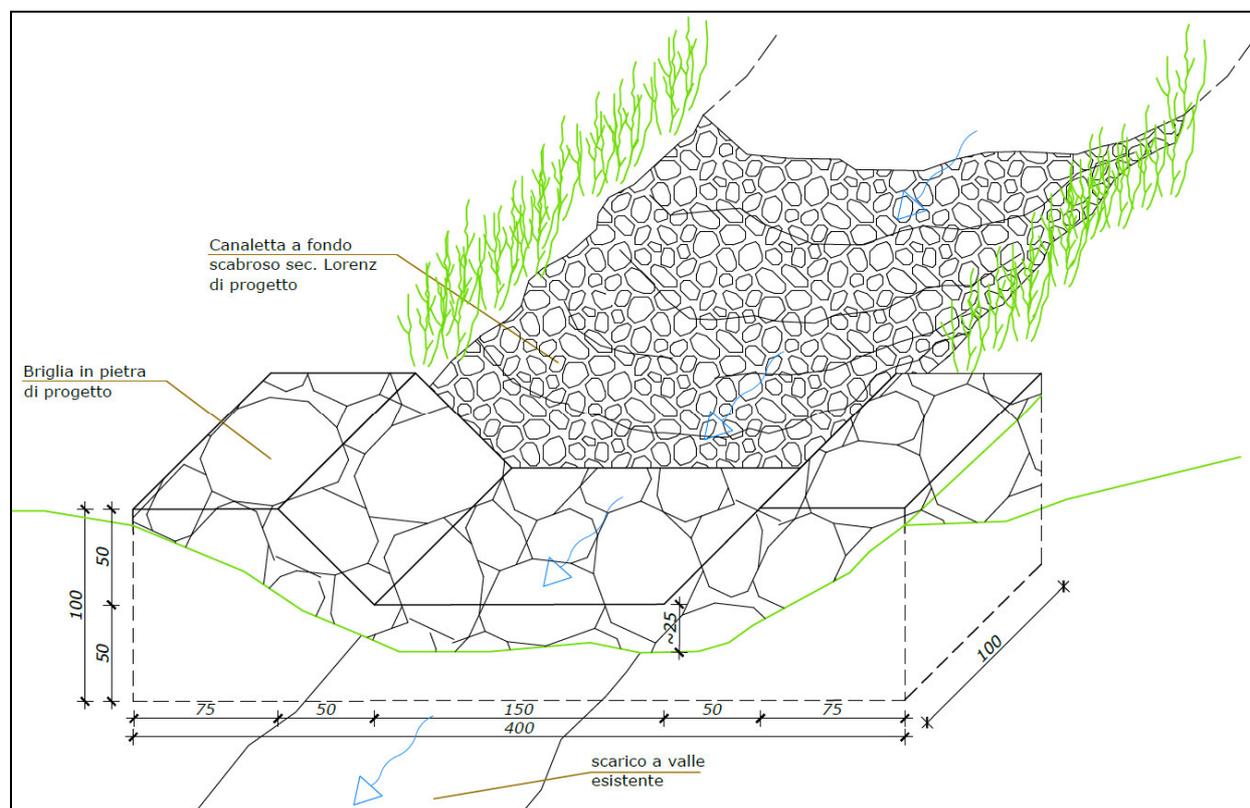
Prospetto canaletta tipo Lorenz con briglia (dal Progetto dell'Ing. Umberto Noris)
